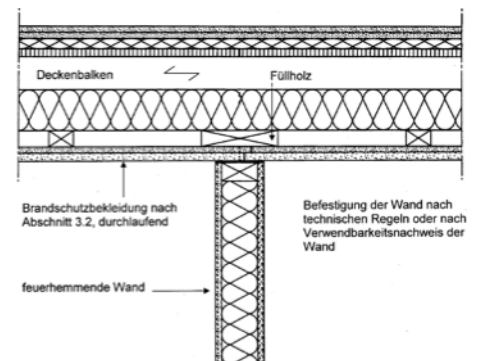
Anschluss einer feuerhemmenden, raumabschließenden, nichttragenden Wand (z.B. Flurwand mit Anforderung feuerhemmend) an eine Decke nach der M-HFH-HolzR
